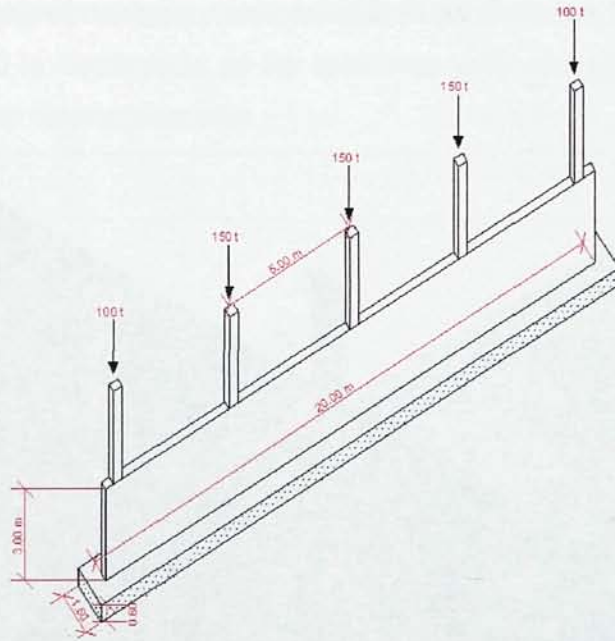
Ejemplo de un muro de sótano sometido a la acción vertical de los pilares de fachada.
